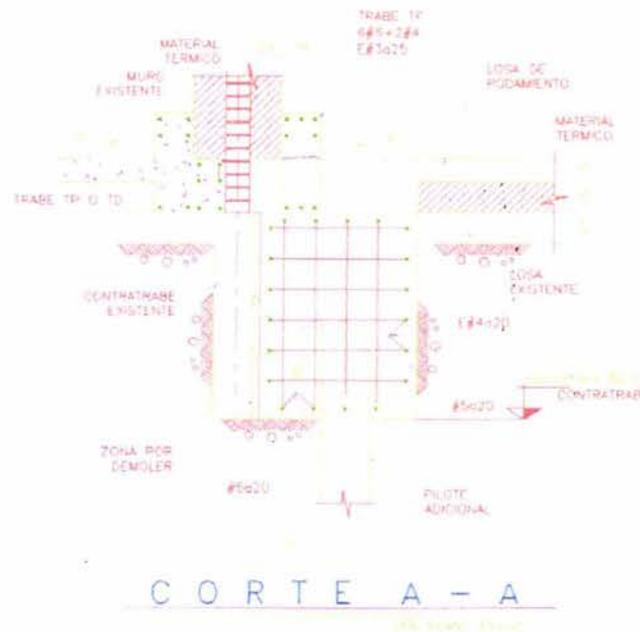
Sección y armado de dado en colindancia y esquina
